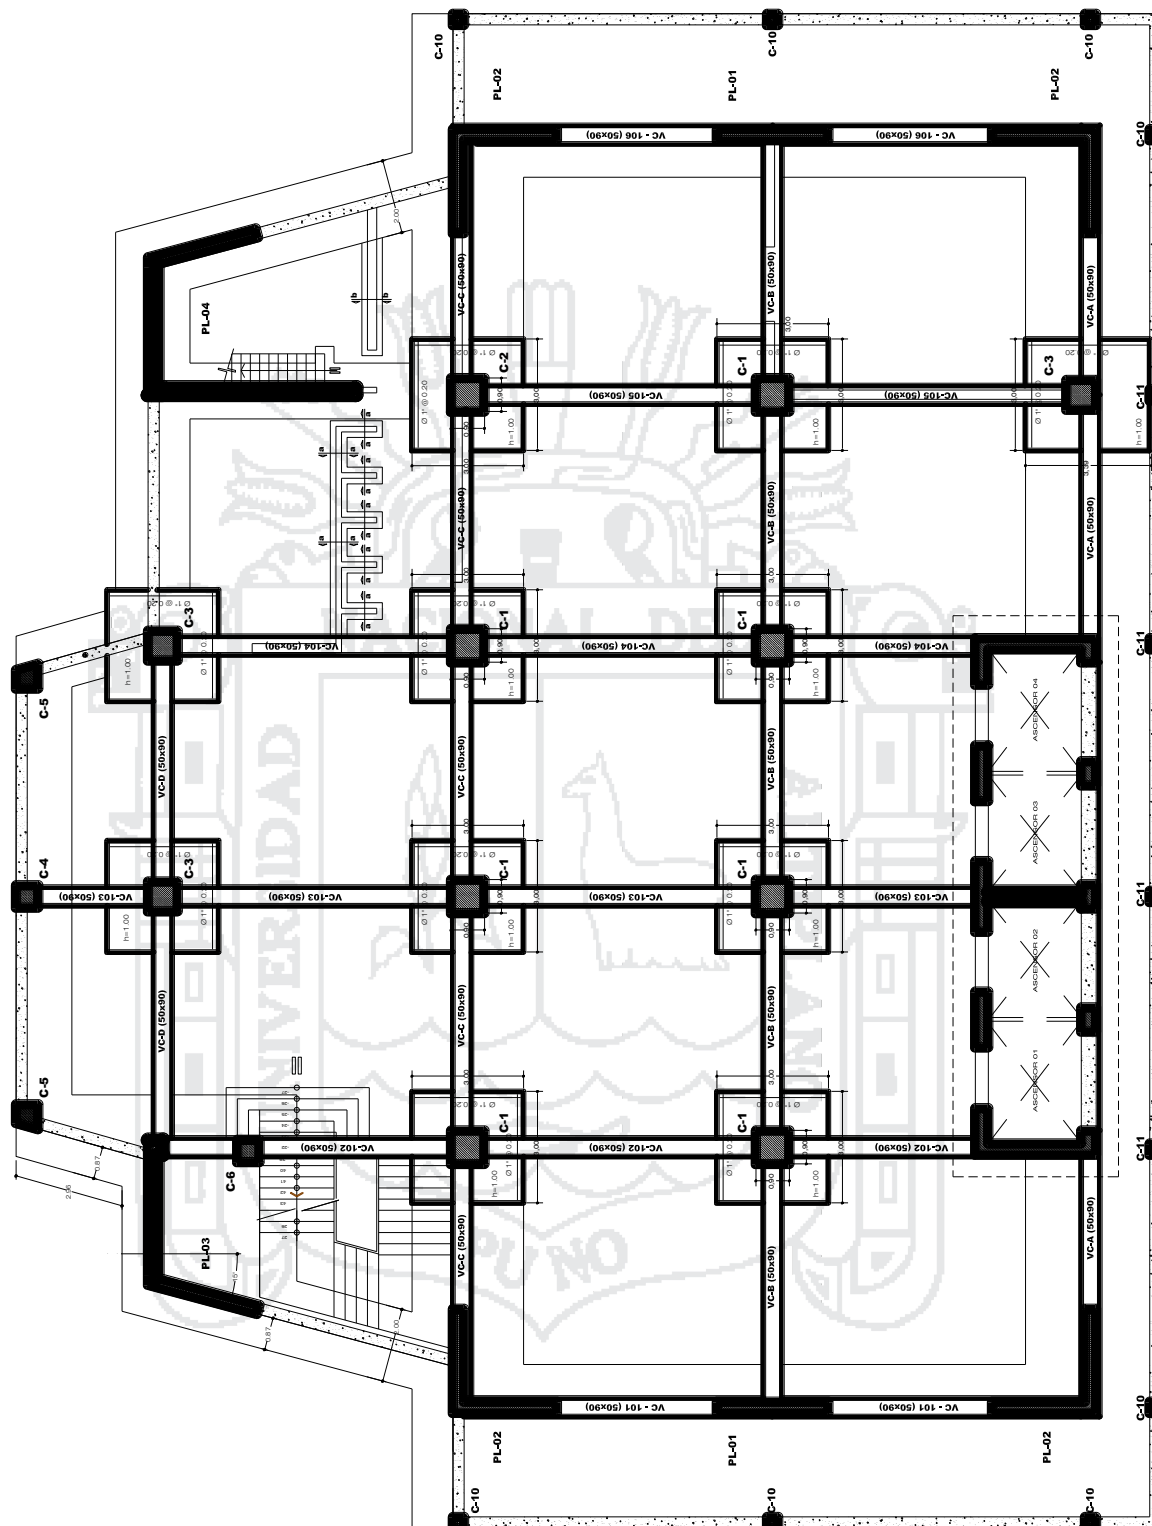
Propuesta estructural planta típica del edificio<sup>51</sup>.
